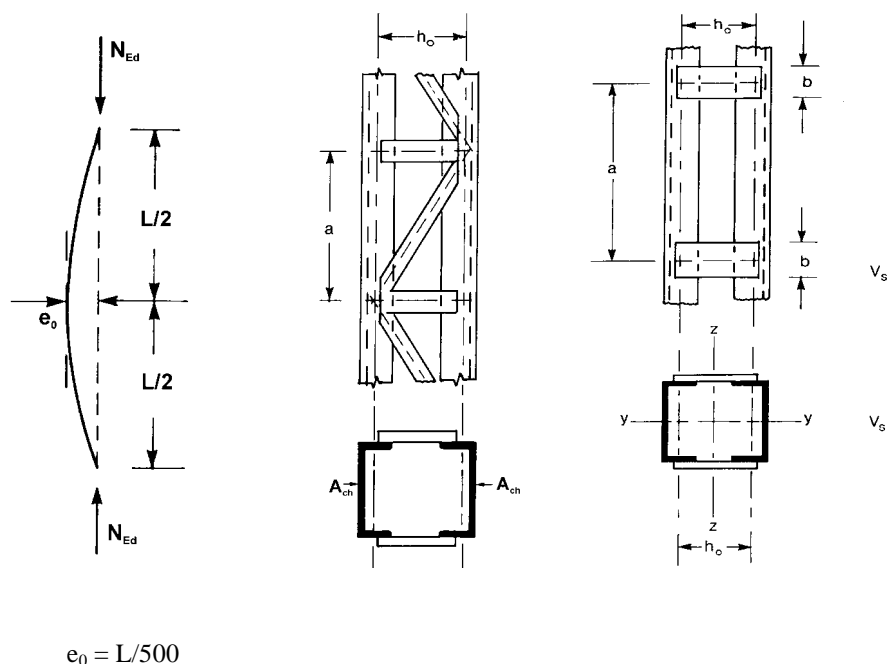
Colunas compostas uniformes constituídas por estruturas travadas por diagonais e travessas
